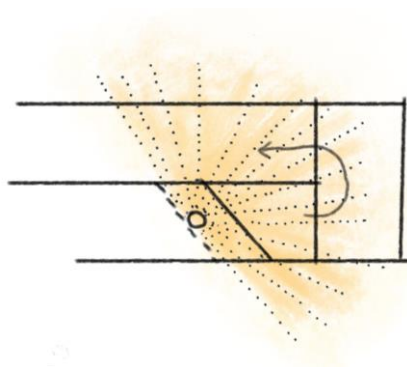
Luz acochada e dirixida pola crebadura. Planta escaleira _Elaboración propia
